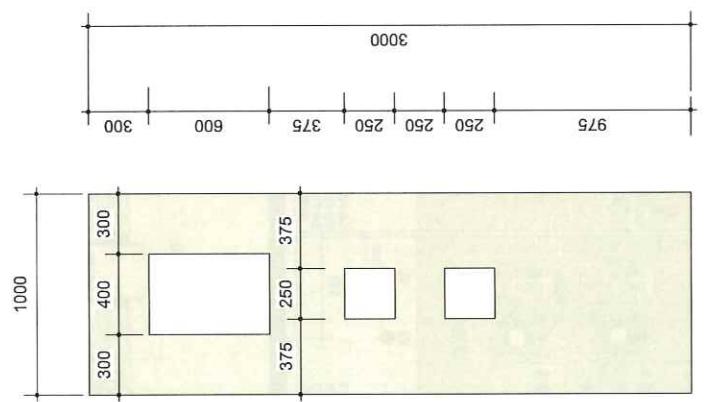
試験体 1 の熱電対位置 (単位 : mm)
